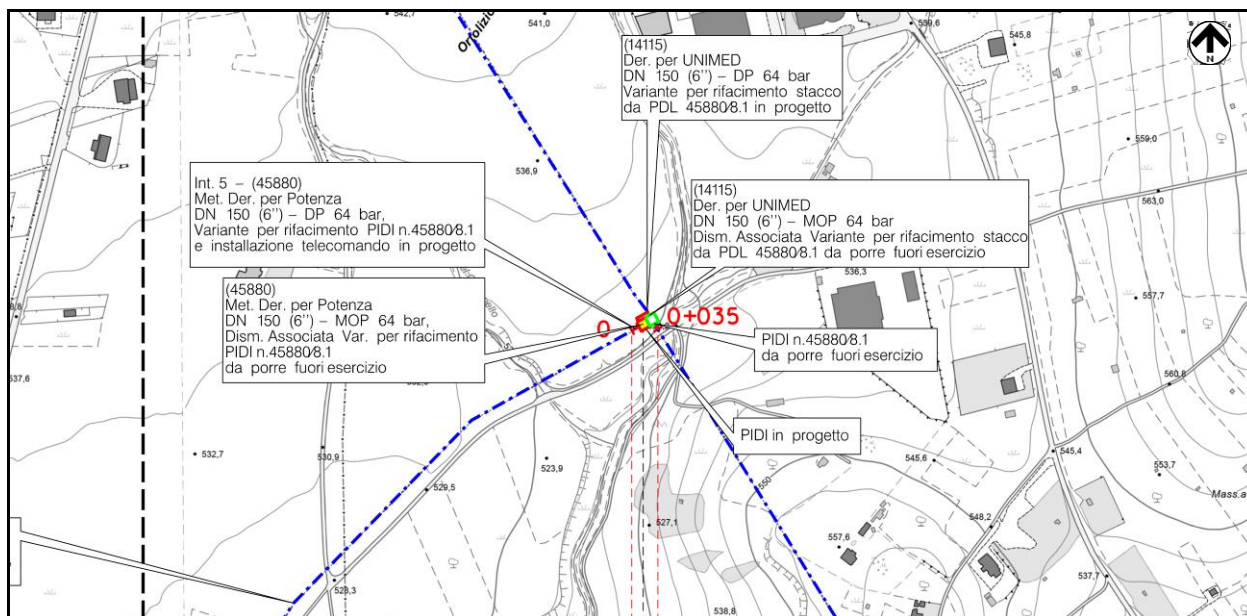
/E.b – Planimetria 1:5.000 con localizzazione dell'area dell'Intervento n.5 (progetto in rosso, dismissione in verde, esistente in blu)
